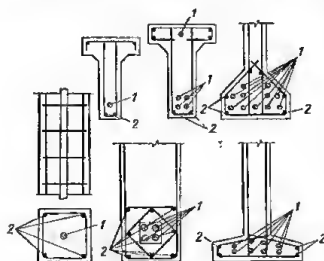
Схемы расположения арматуры в поперечном сечении предварительно напряженных железобетонных элементов:
